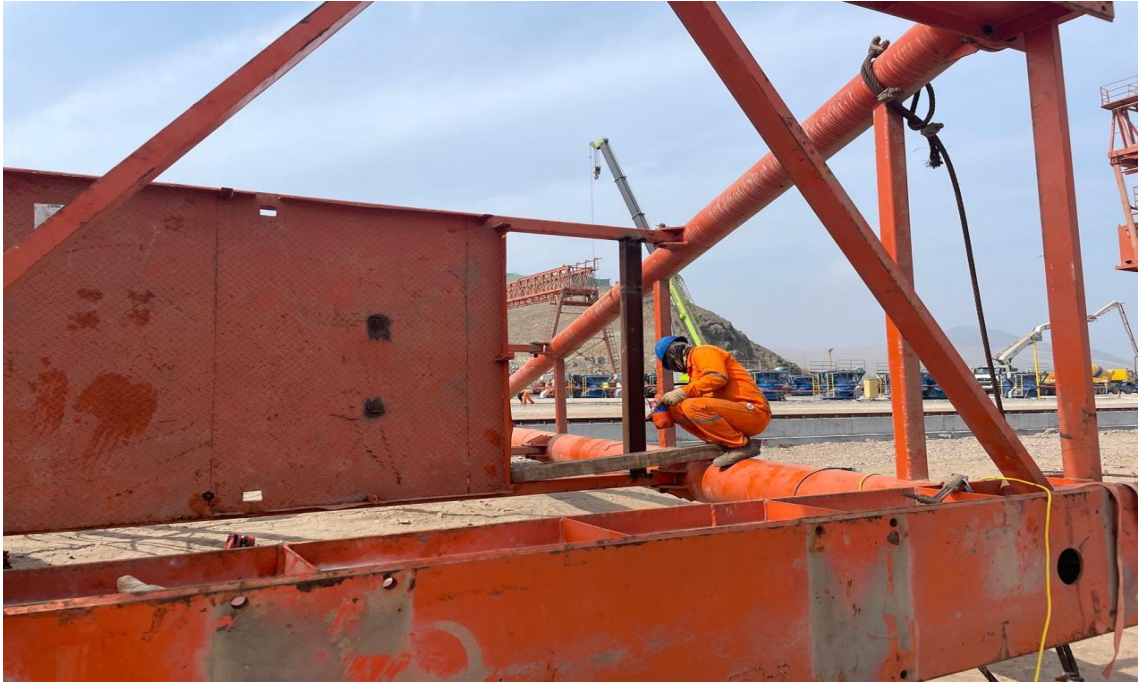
Soldadura de estabilizadores 02.
